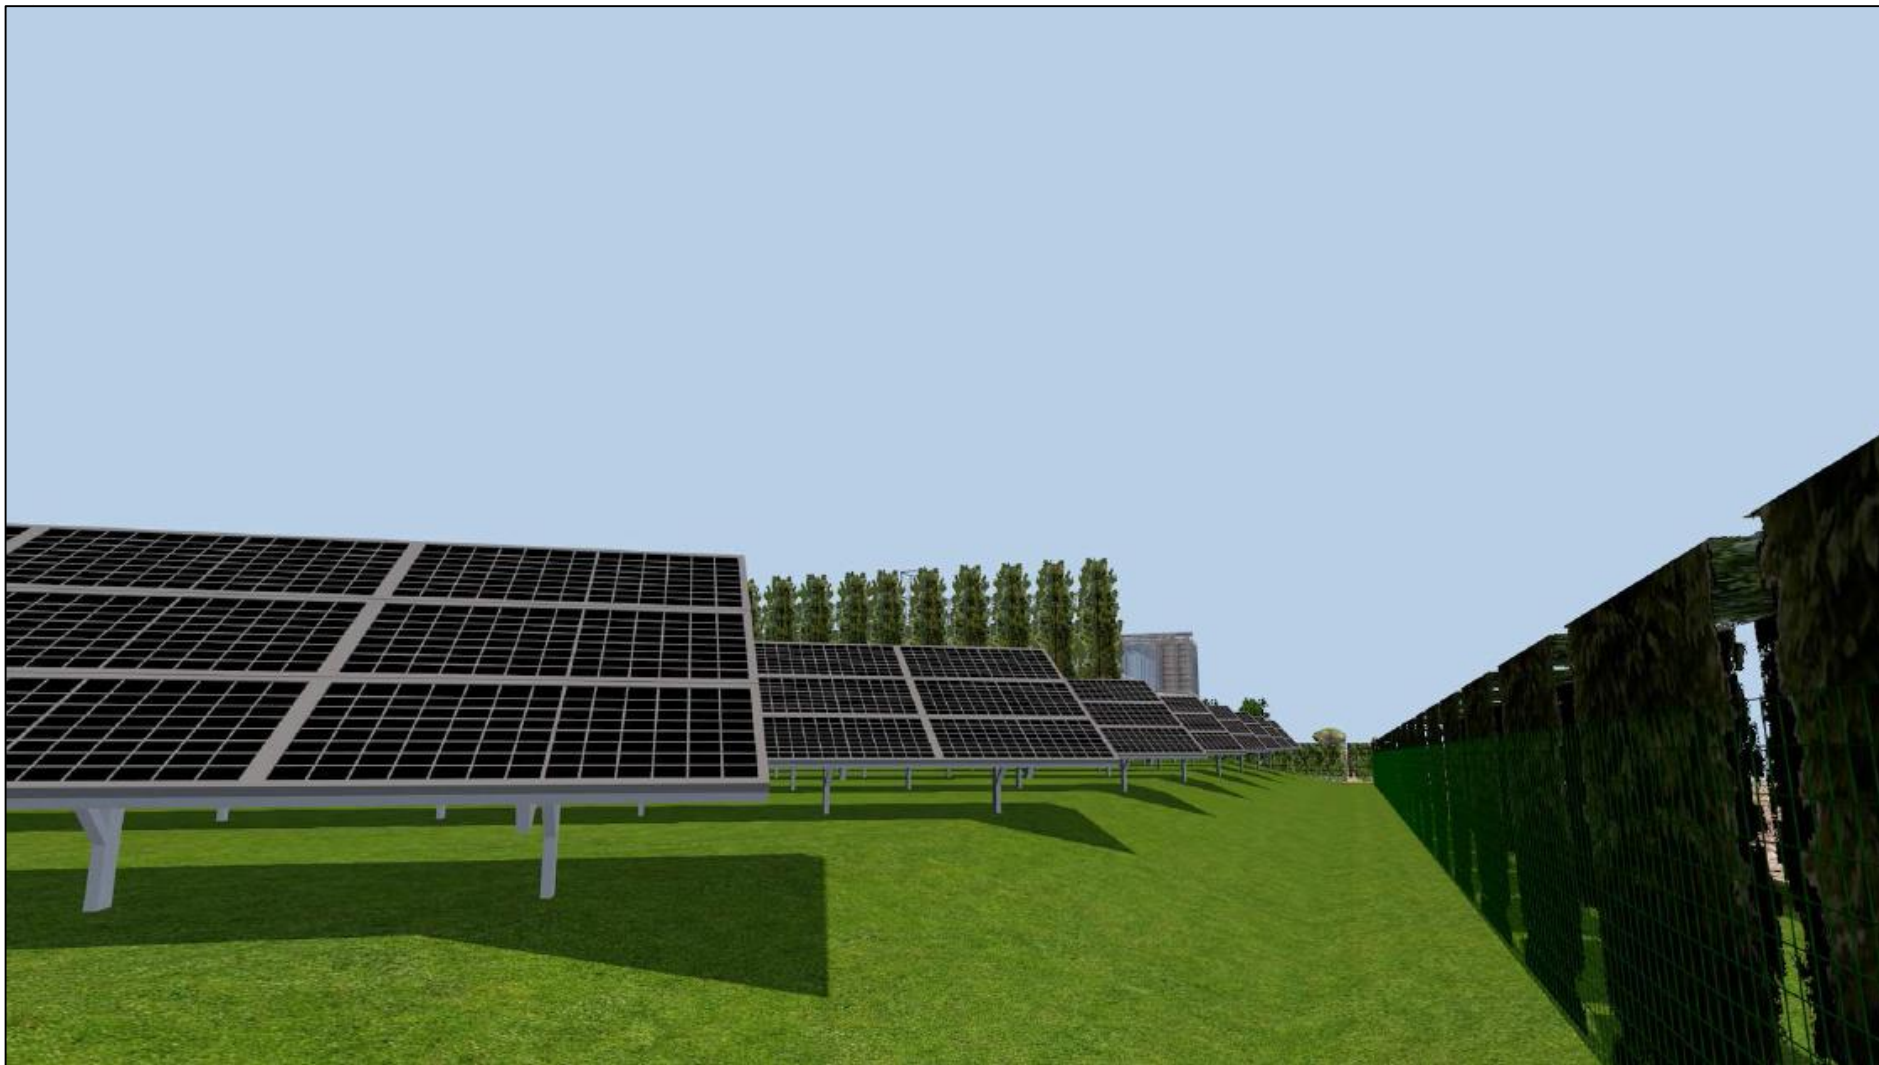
Stralcio elaborato "D.d.27 Rendering planivolumetrico del progetto" allegato nella risposta alla richiesta di integrazioni; il poligono azzurro indica la porzione sottoposta a variante.
